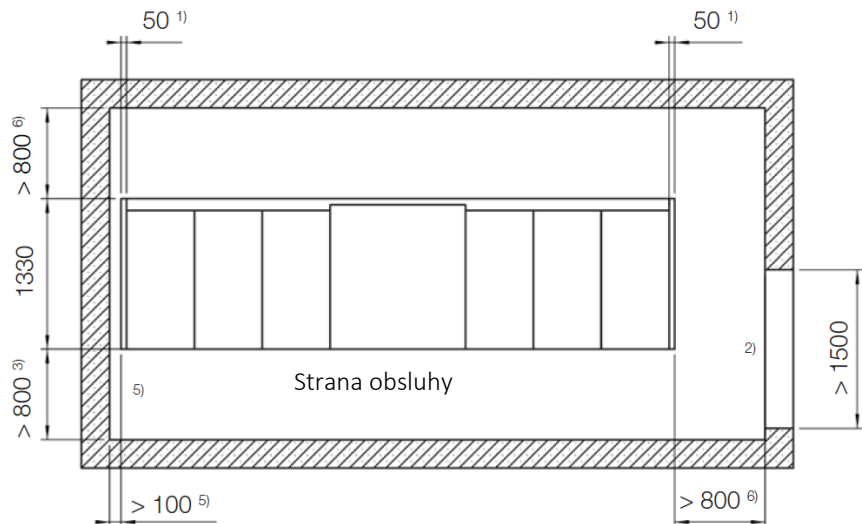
Instalace a montáž ke zdi, příklad instalace ve dvou řadách (pohled shora / půdorys, rozměry v mm)
